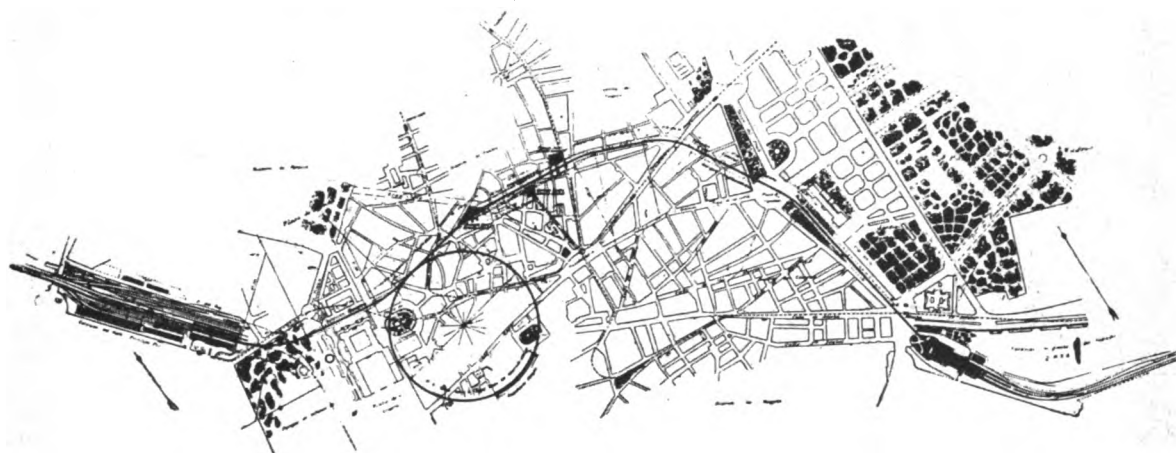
Planimetria della ferrovia sotterranea di collegamento Nord-Sud di Madrid. (Progetto Reyes 1910).
